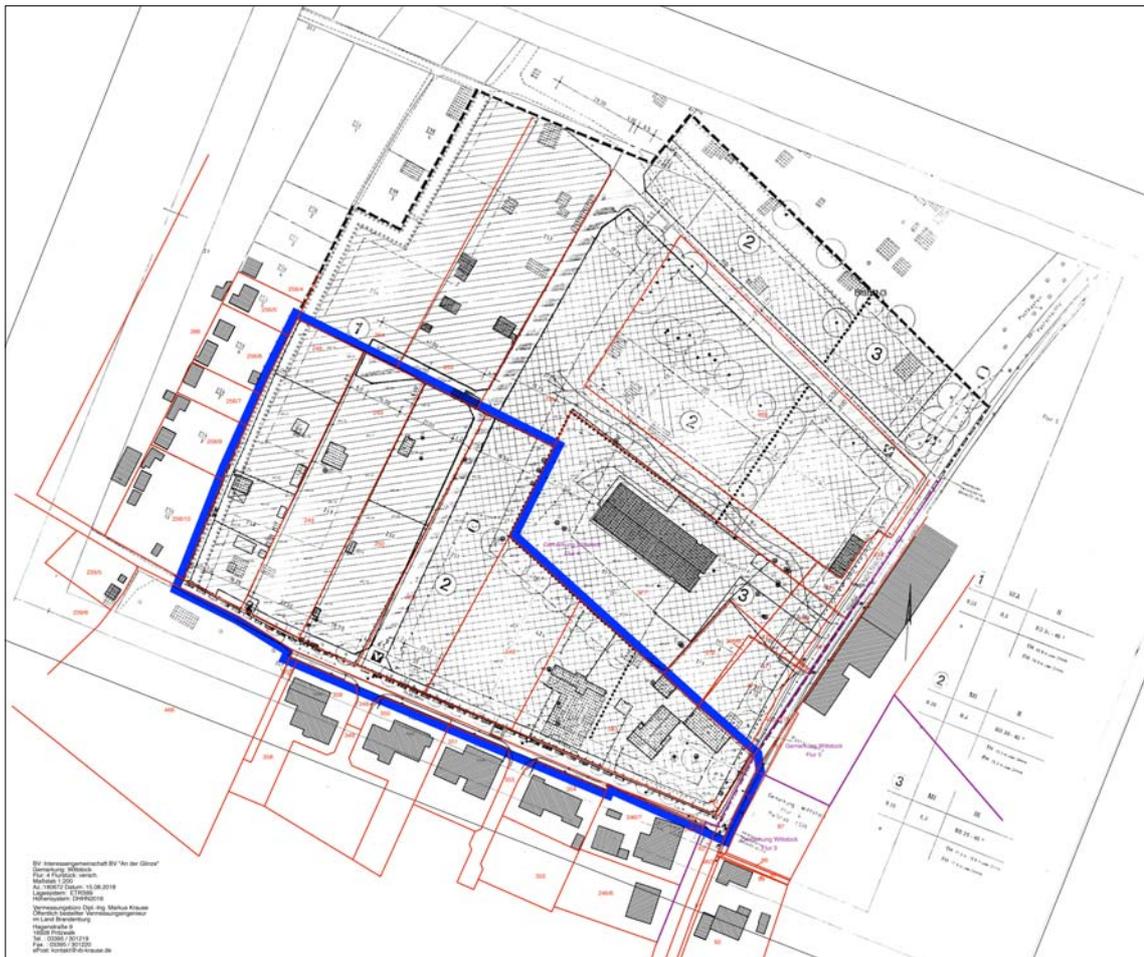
Bauungsplan Nr. 04/3.3/93 "Ringstraße" der Stadt Wittstock/Dosse
